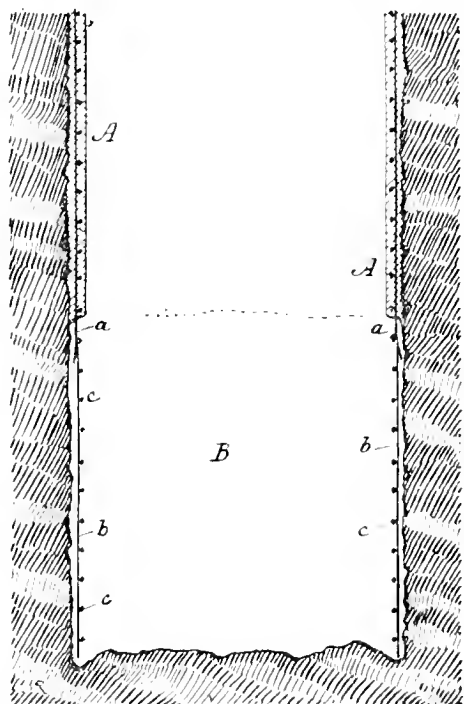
Coupe verticale d'un puits en ciment armé.
